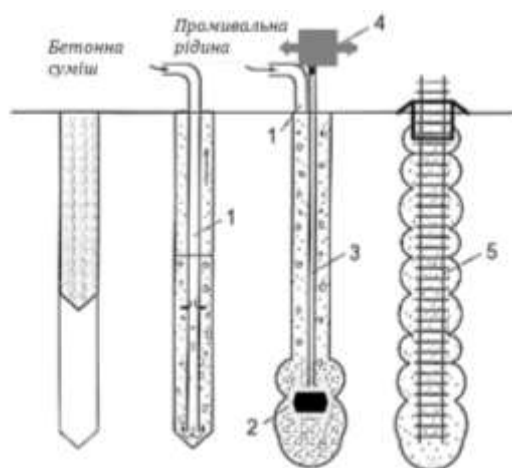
Схема свердловинного облаштування набивних паль: 1 – подавальні труби; 2 - розширювач; 3 – бурильні труби; 4 – обертач; 5 – армувальний каркас
